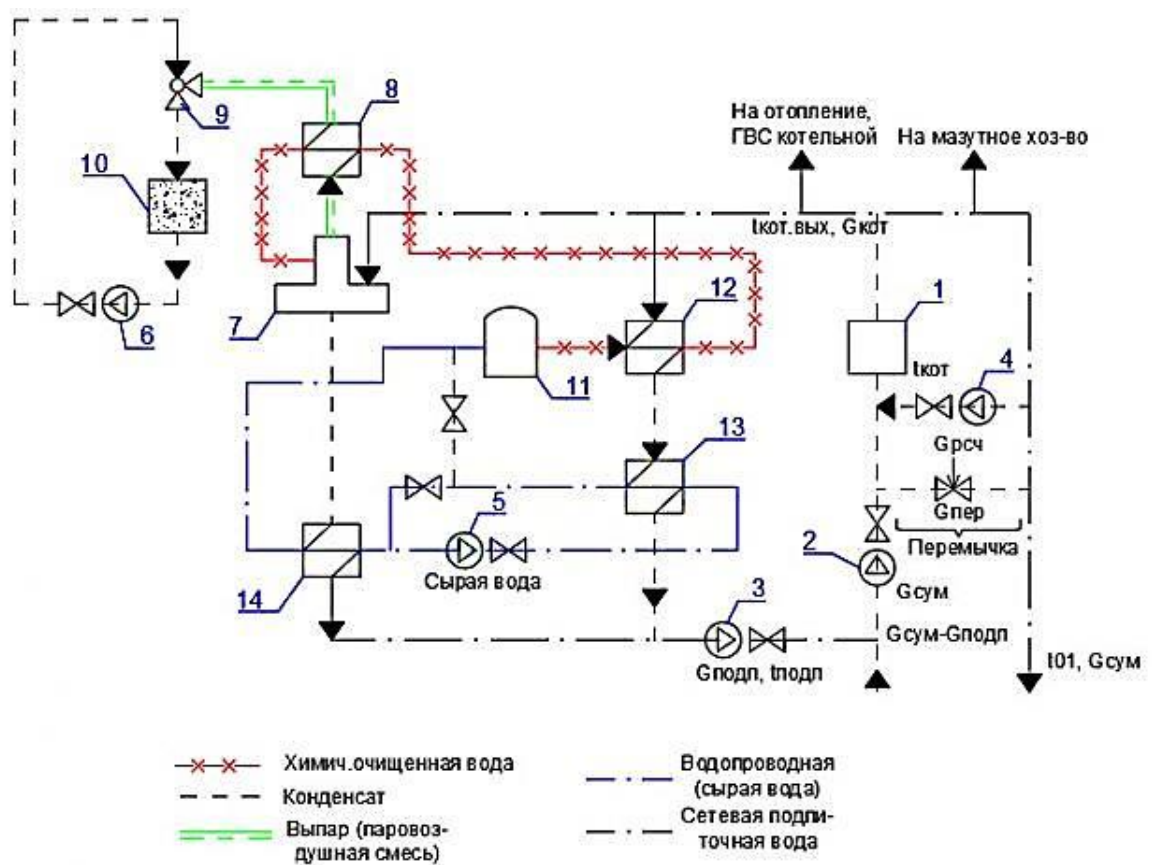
Тепловая схема котельной с водогрейными котлами
